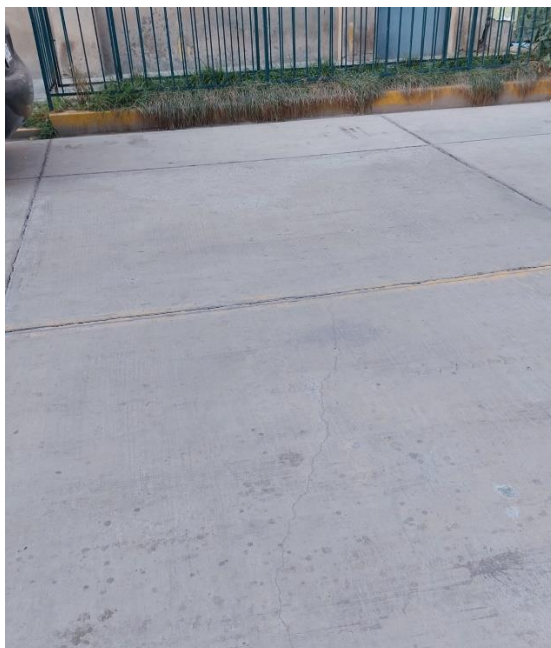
Fallas de losas con fisuras transversales entre Av. Mariategui y Jr. Manuel Alonso.
